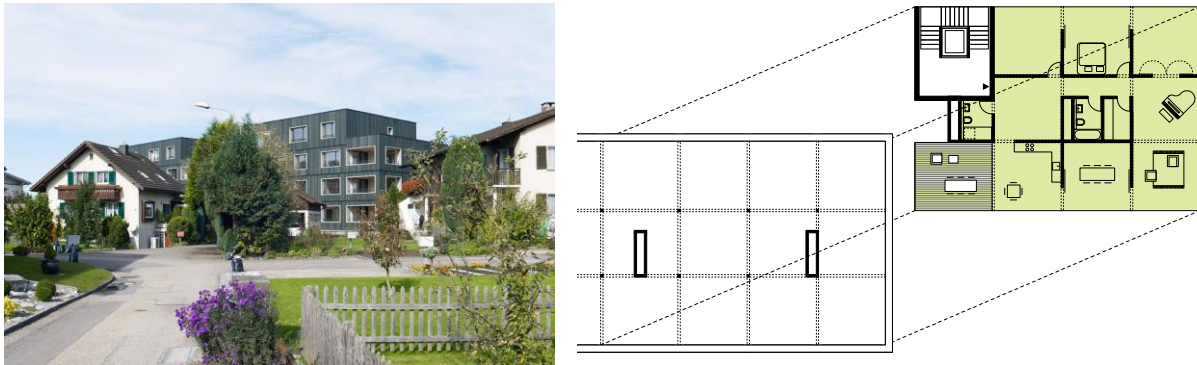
projet pilote Swisswoodhouse à Nebikon/LU, photo et plan / Bauart Architekten und Planer AG
